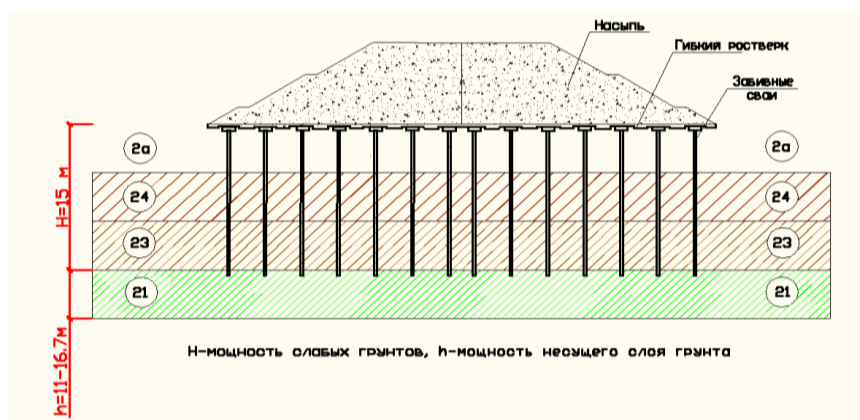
Устройство свайного основания с гибким железобетонным ростверком
